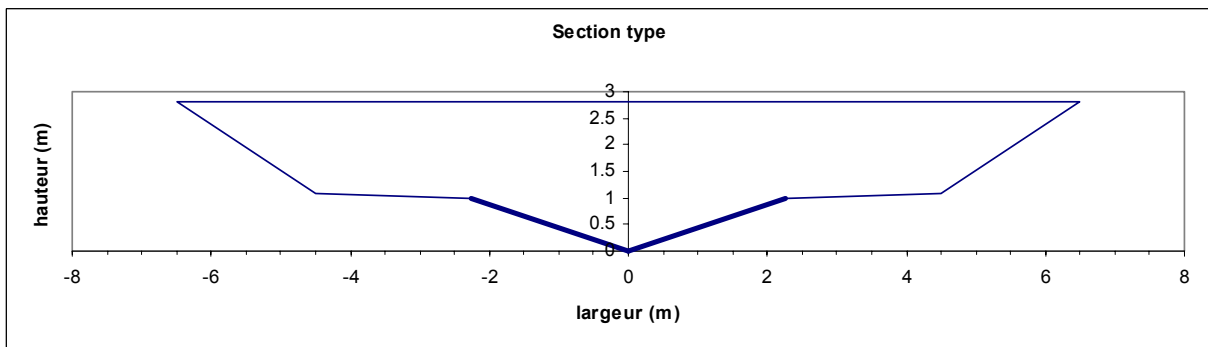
Section type de l'Yzeron à Oullins (rapport d'échelle verticale/horizontale=1). La partie épaisse correspond à la cunette béton. La hauteur bétonnée est de 1 m.
